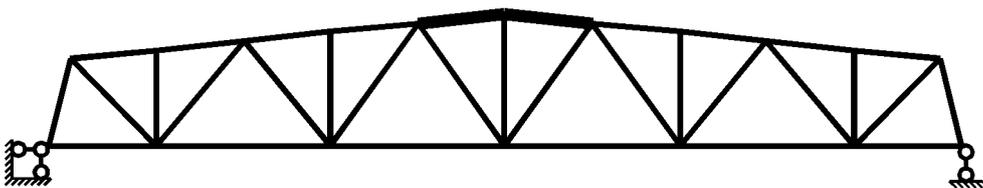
Усиление фермы увеличением сечений стержней верхнего пояса
